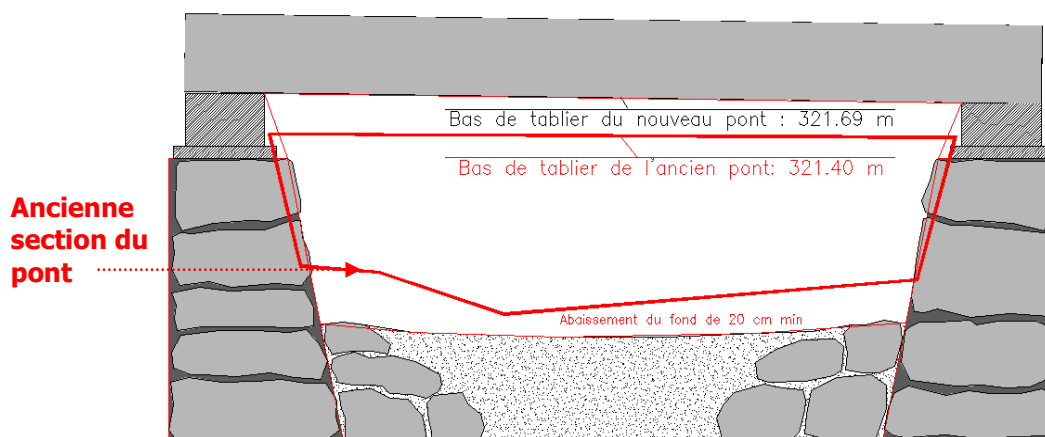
Coupe du pont du Boulodrome – Face amont (en rouge la section de l'ancien pont)
